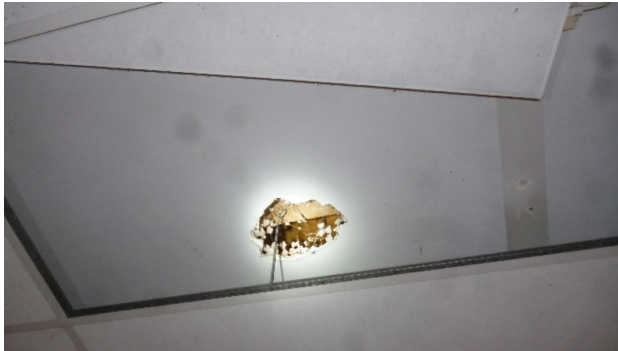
Oudere vaste plafonds van stuc-op-steengaas.
